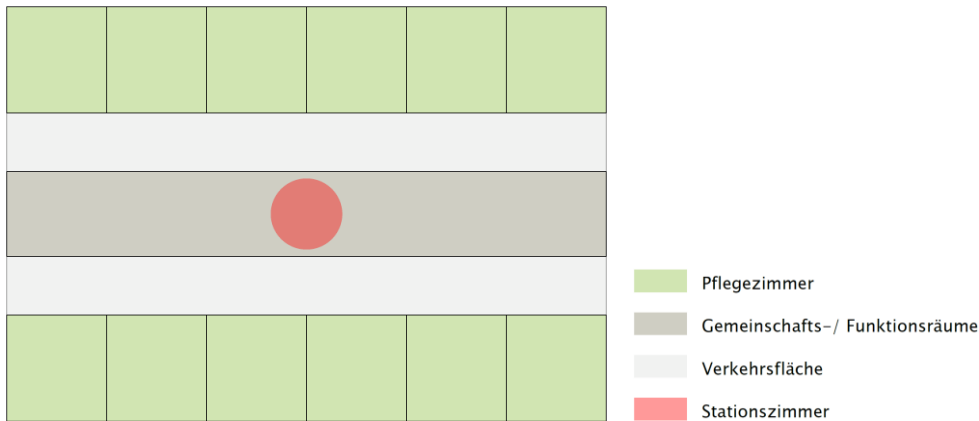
Linearer Grundriss mit zwei Korridoren
